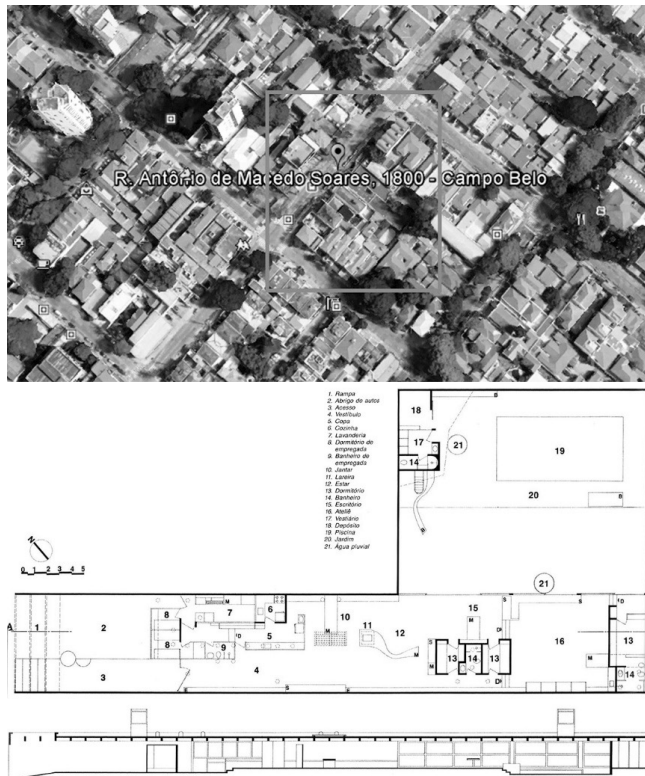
Casa Tomie Ohtake. Situação planta e corte.
